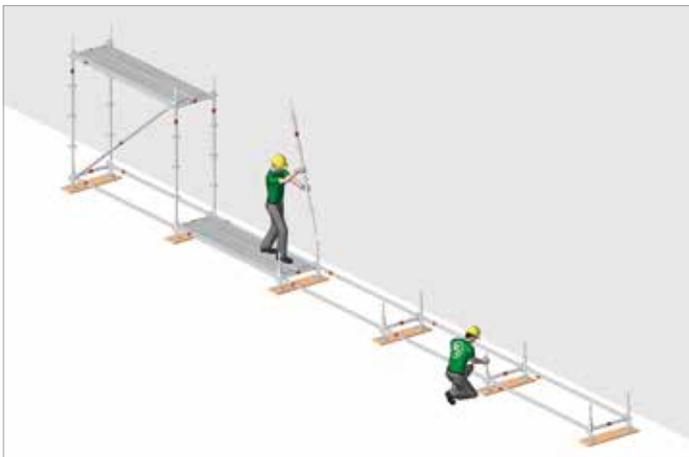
Vollständig montiertes erstes Gerüstfeld mit Grundrahmen der weiteren Felder
